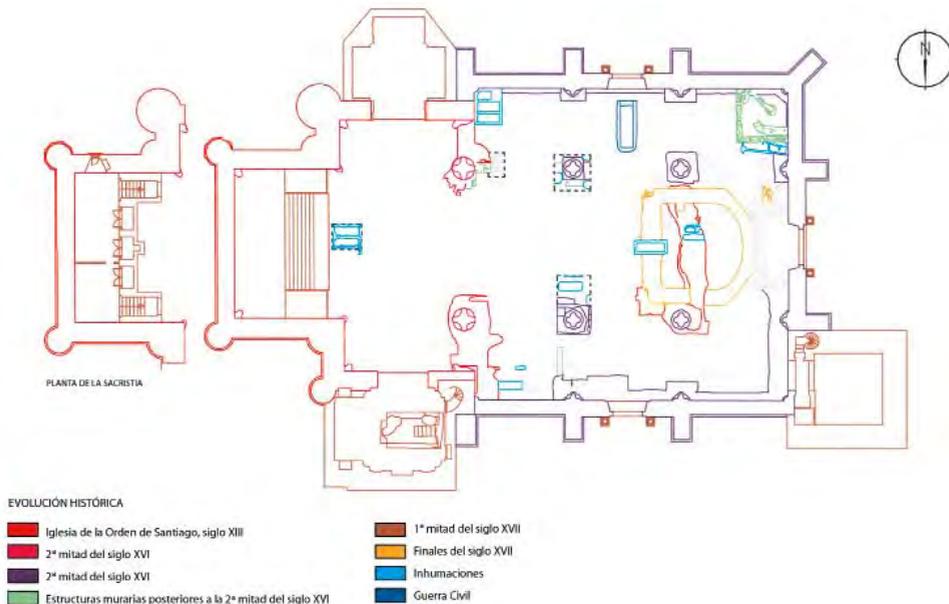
Planta de la iglesia y de las estructuras documentadas durante la intervención arqueológica.
